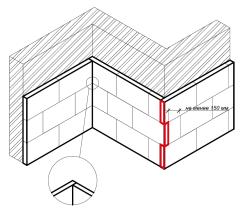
Схема перевязки плит на внутренних и наружных углах здания
